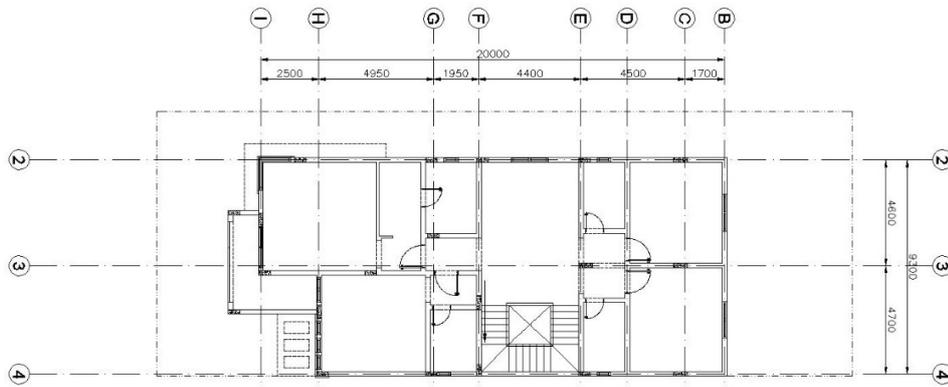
Planta alta arquitectónica. Proyecto Obhur.
